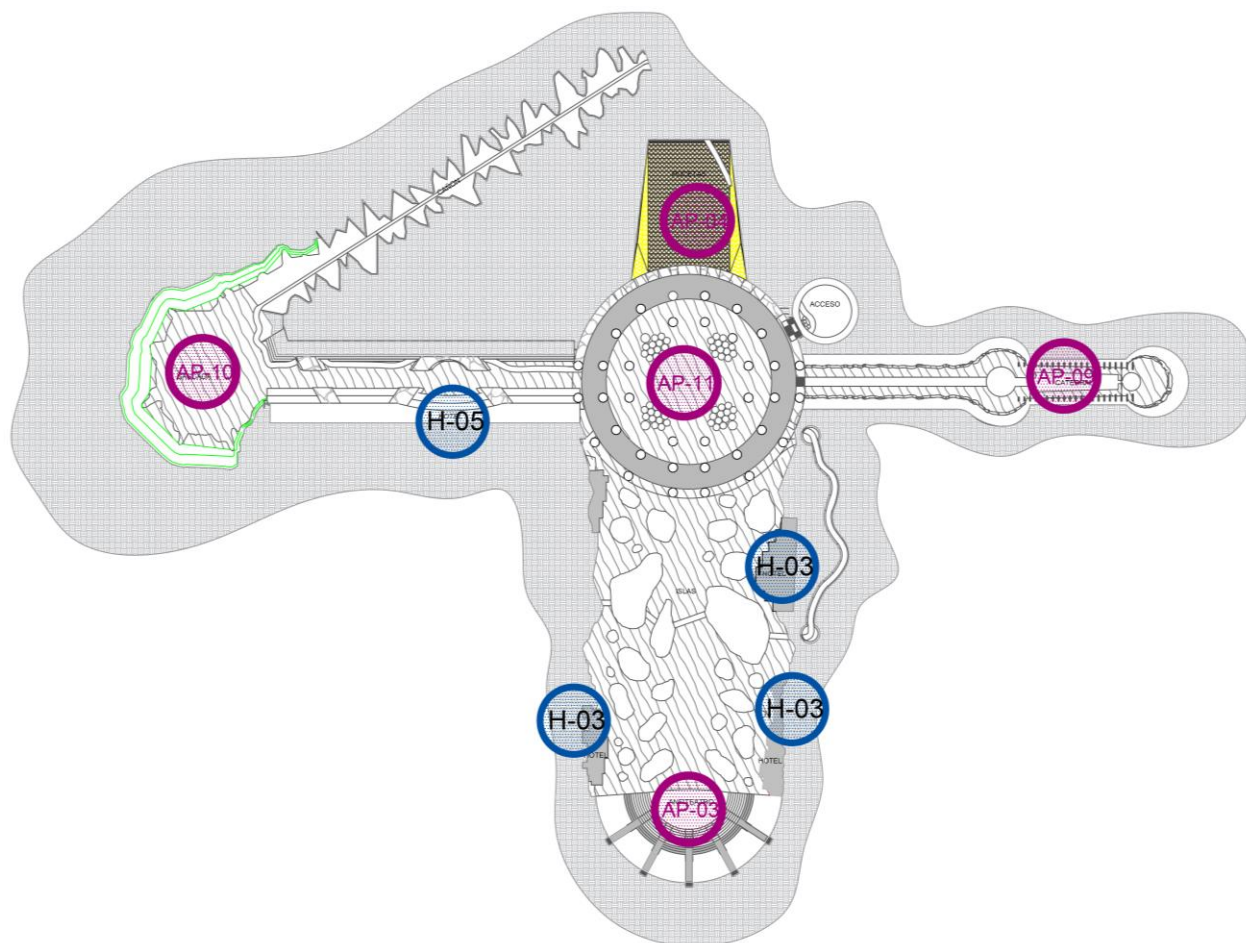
Plano esquemático de proyecto Nivel -30.00.
